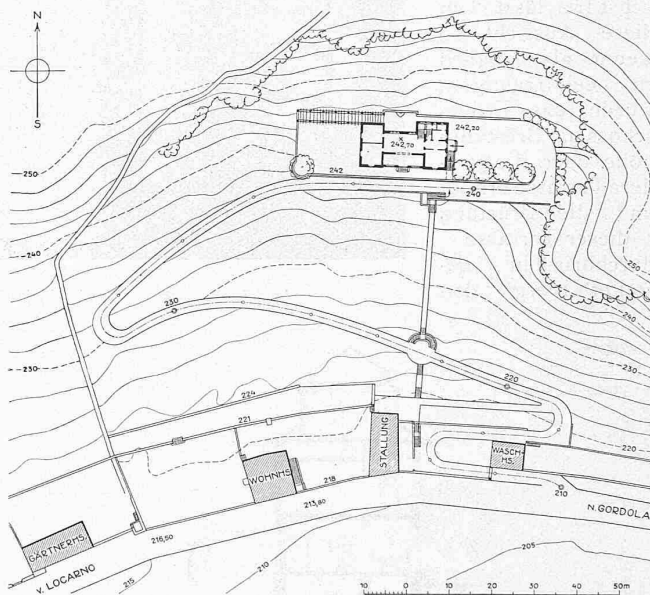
Landhaus Verbanella bei Locarno, Lageplan 1:1600.
